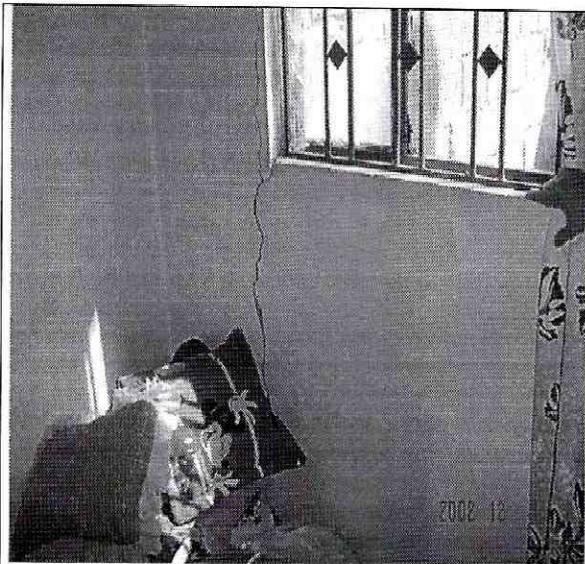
Agrietamiento vertical muro fachada posterior en segundo piso.
